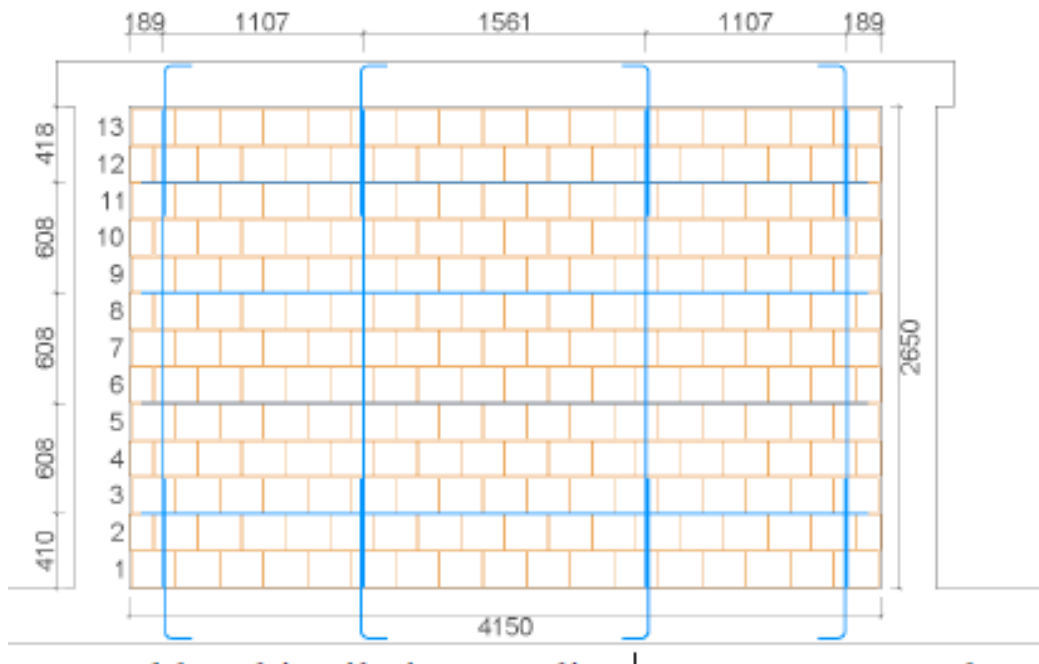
Mampostería reforzada Fuente: (Guidi, da Porto, Dalla Benetta, Verlatto, & Modena, 2013)
